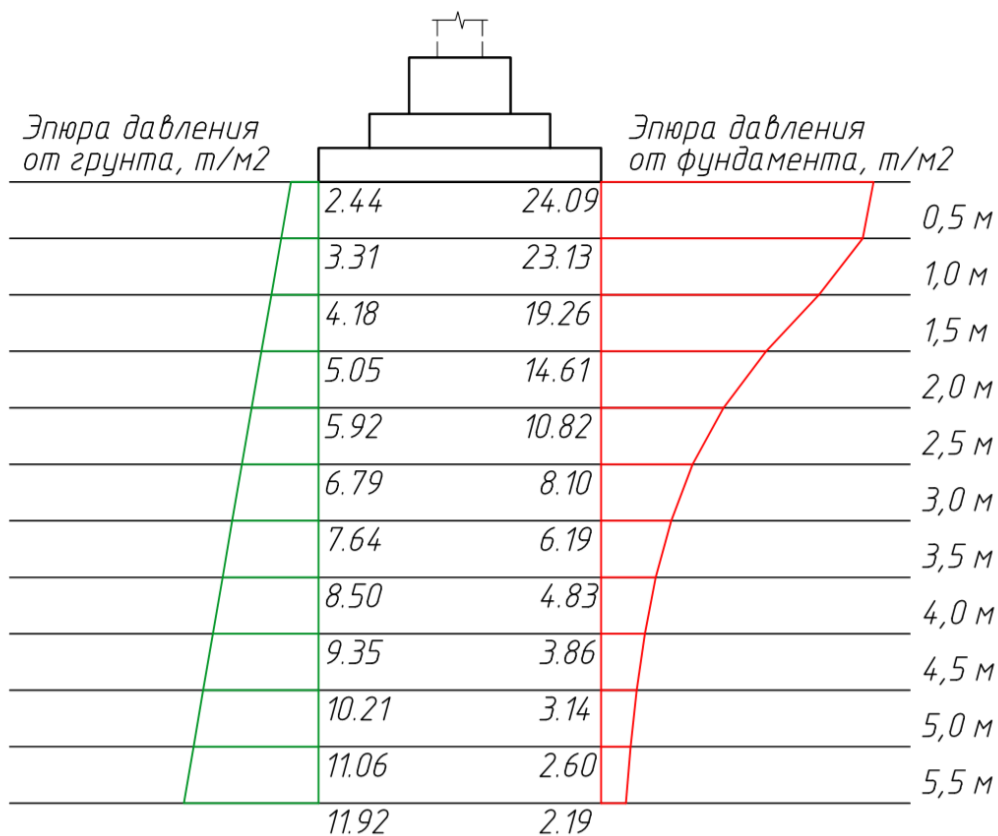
Расчет осадки: эпюры напряжений от фундамента и грунта
